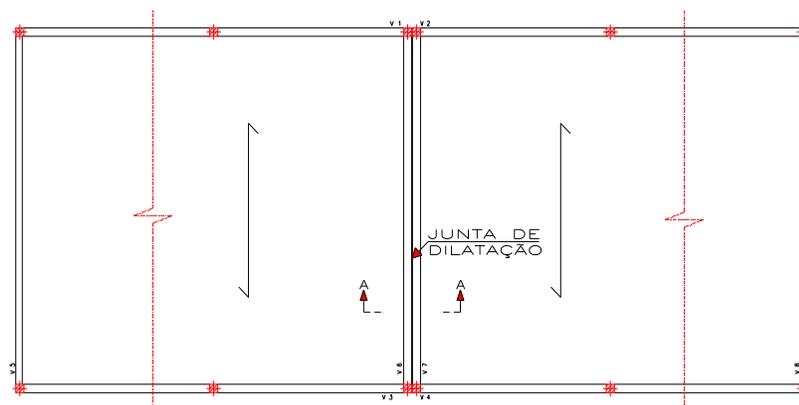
Junta de dilatação vista em planta.
